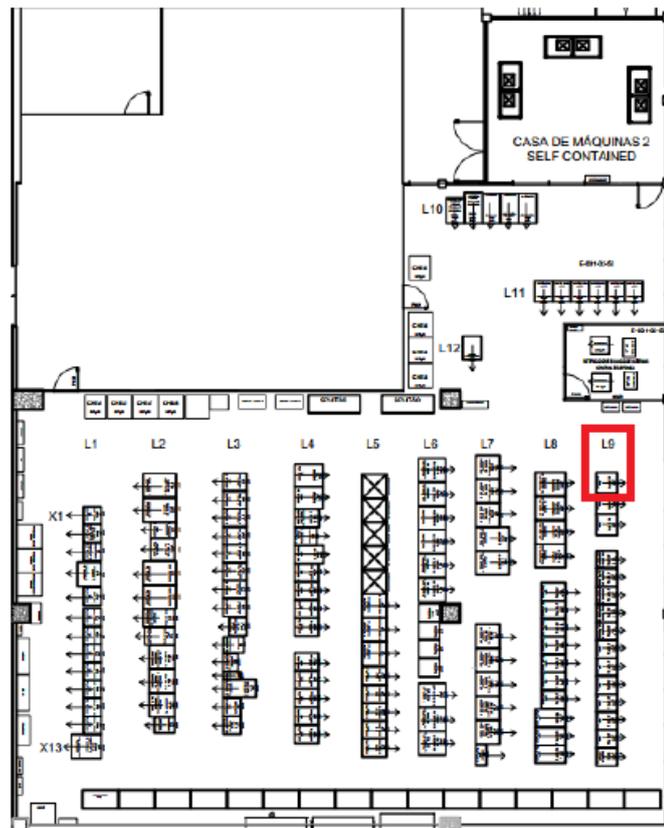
Planta baixa da Sala de Servidores (ENGENHARIA, 2020)
